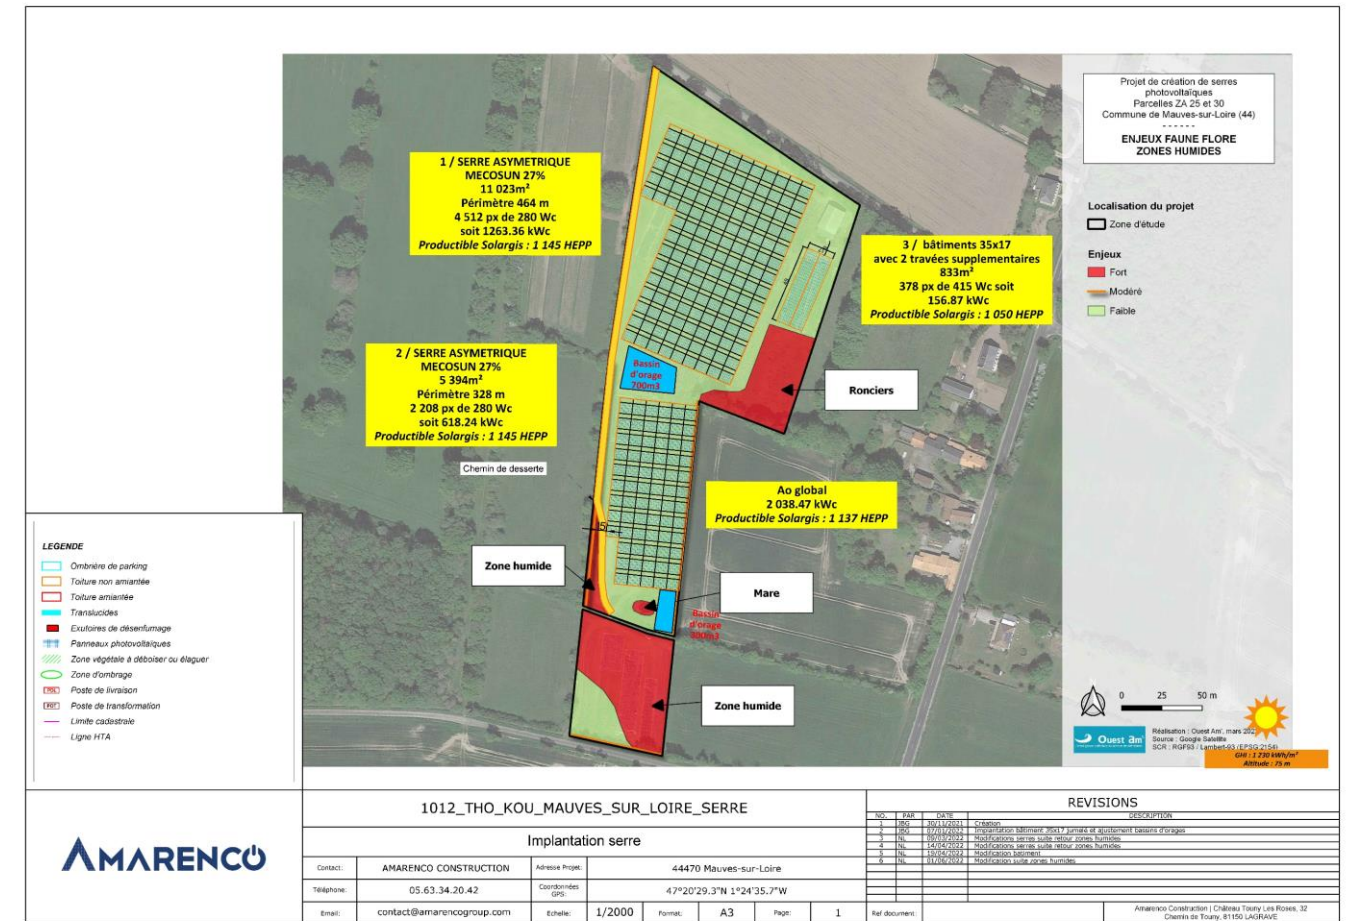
Plan implantation initial – Juin 2022 – THO Kou (Source : AMARENCO)
